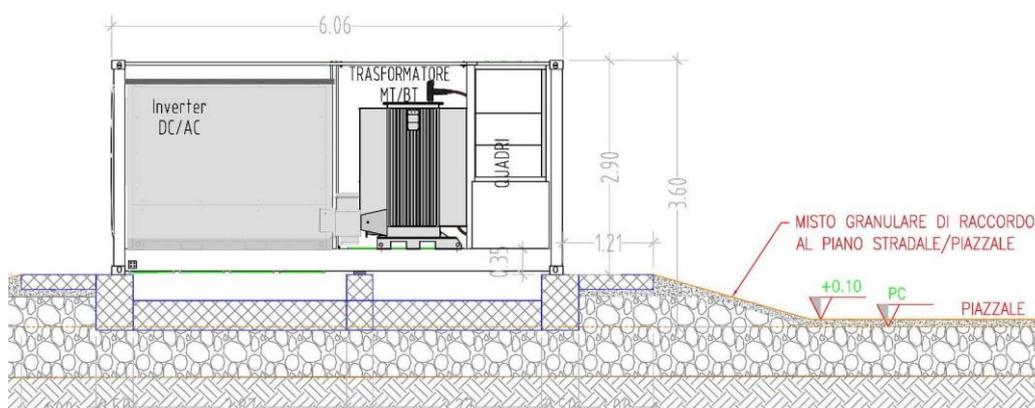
SEZIONE TIPO AREA POWER STATION
